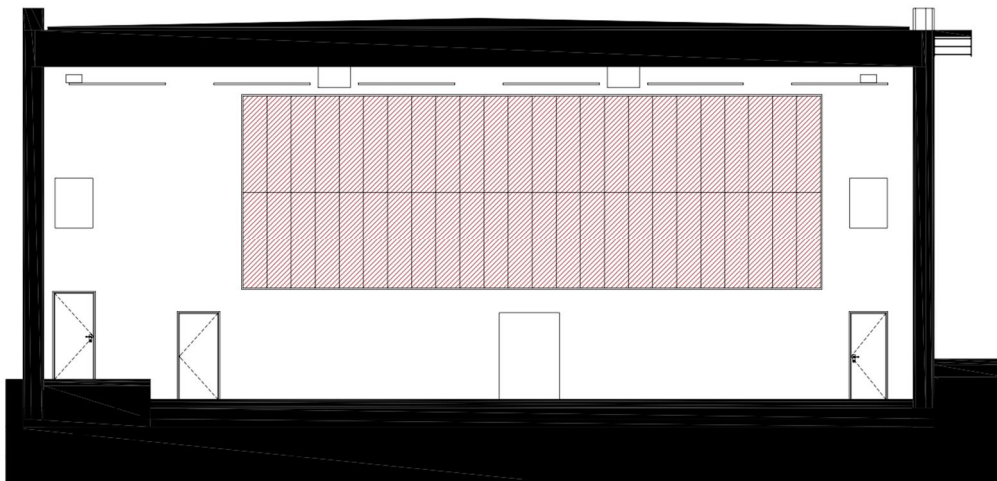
Prospetto Ovest con indicazione dei pannelli a parete (pannelli in fibra di legno mineralizzata con retrostante pannello in lana di roccia spess. 75mm)
